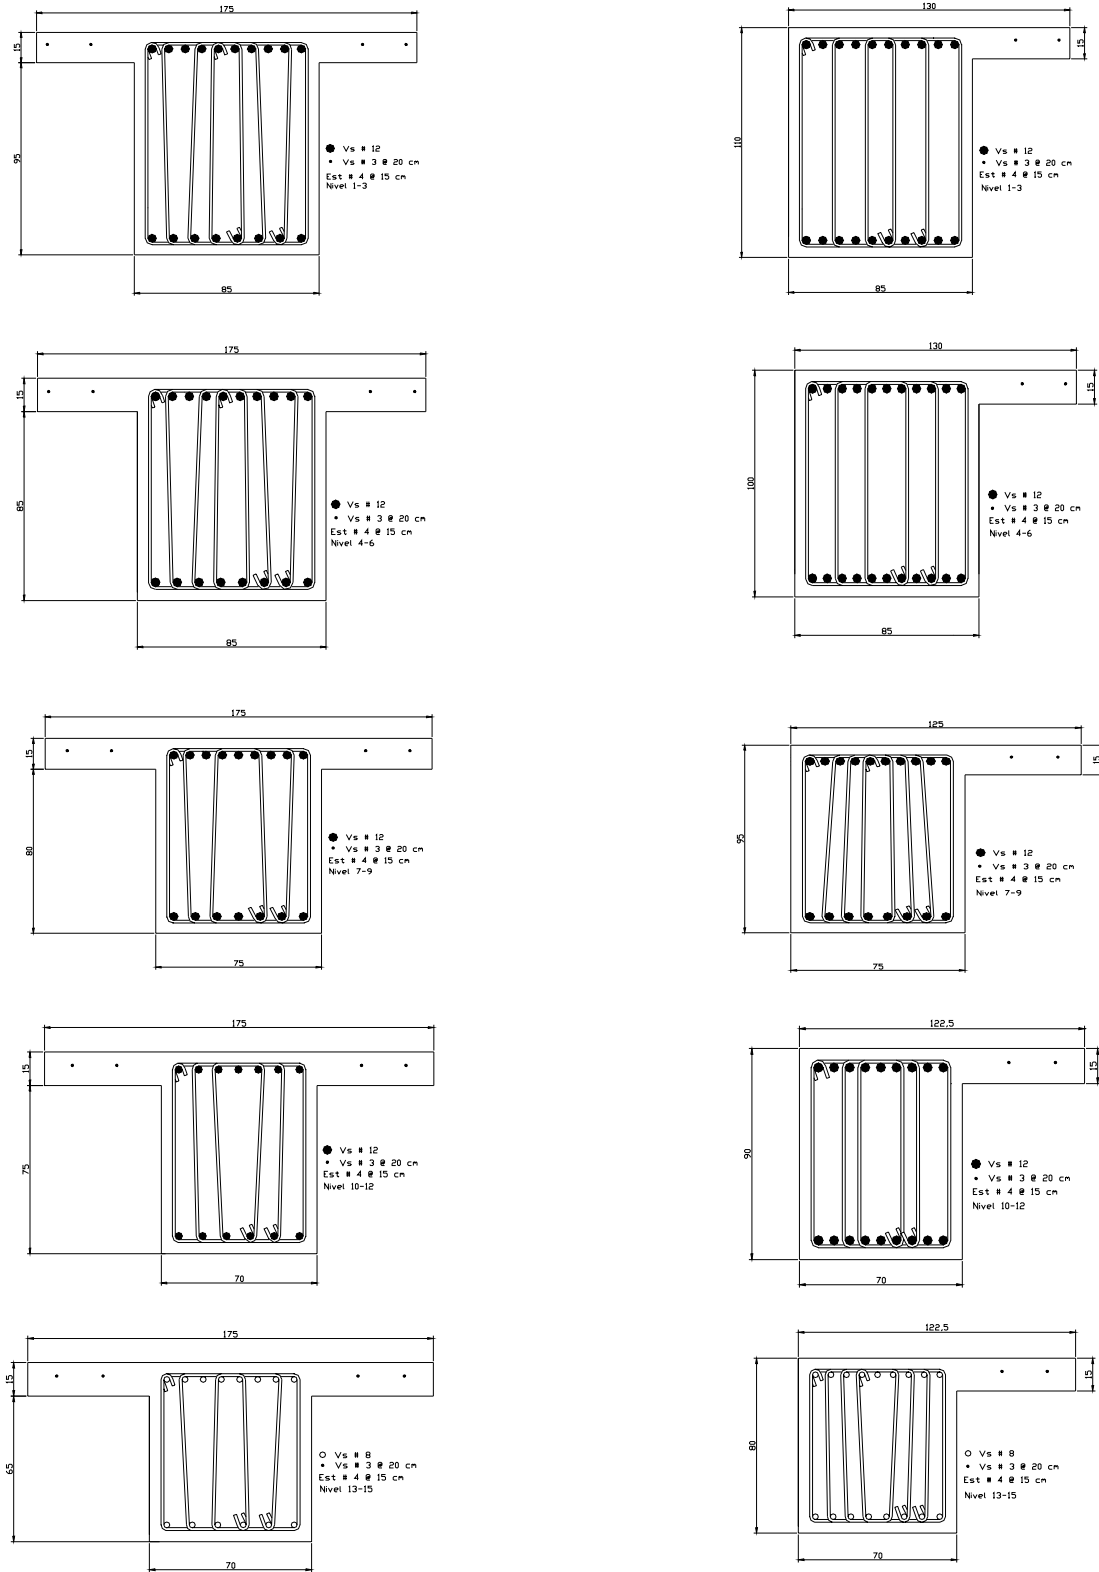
Detallado de Vigas de Marcos Interior y Exterior respectivamente, Dirección Y para el Edificio B.
